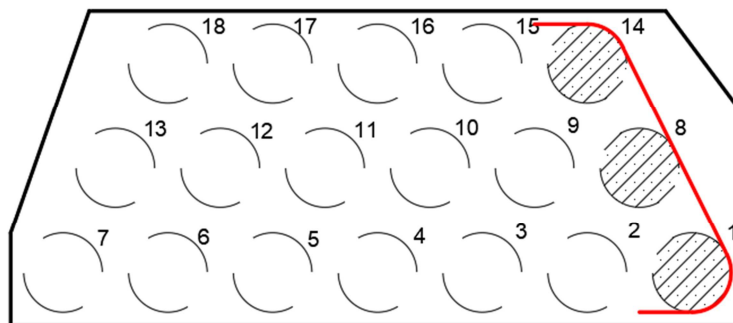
Gruppo di 3 pali di fondazione maggiormente caricati
